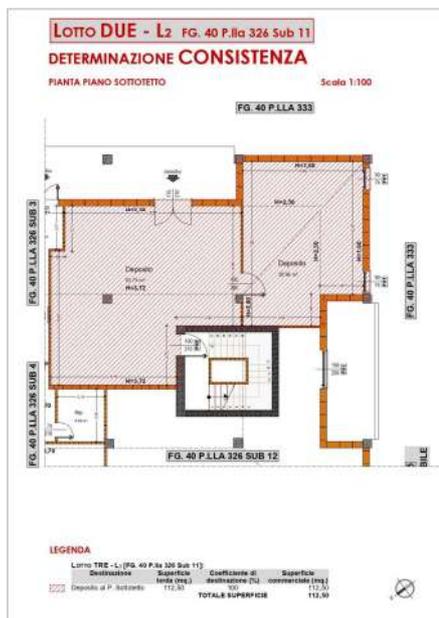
Determinazione consistenza Lotto L2 (ALL. 11).
